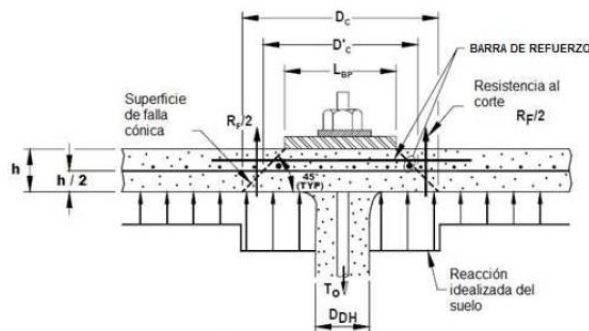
Corte por punzonamiento en pantalla de hormigón
